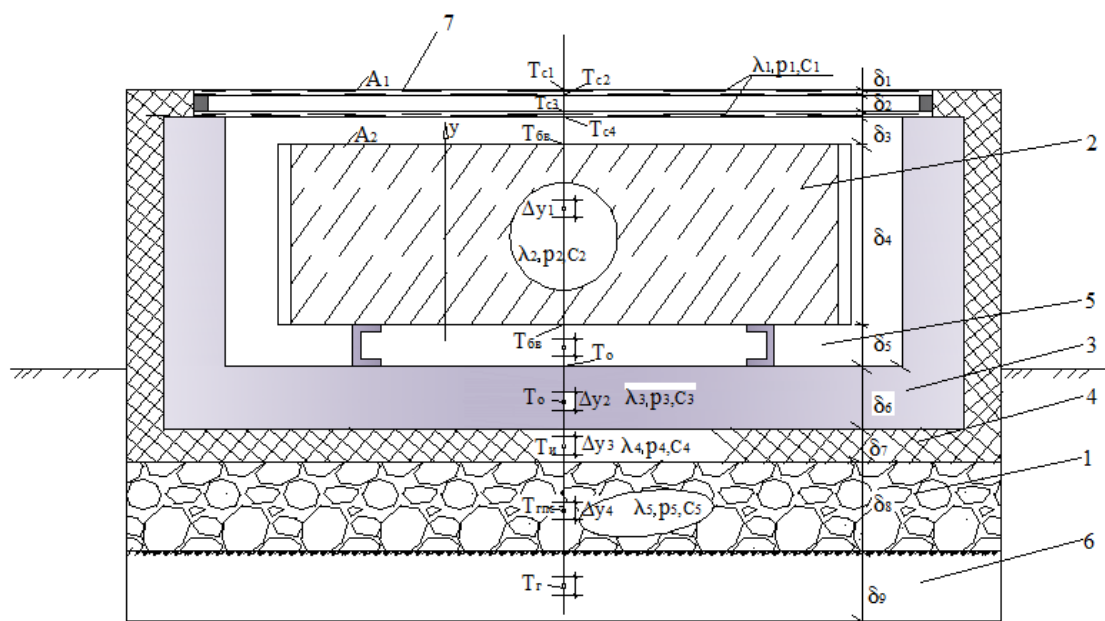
Расчётная схема для математического описания температурного режима гелиокамеры: керамзит; 2-бетонное изделие; 3 - корпус гелиокамеры; 4- слой теплоизоляции; 5-воздушная прослойка; 6-грунт; 7-двухслойное прозрачное покрытие.
